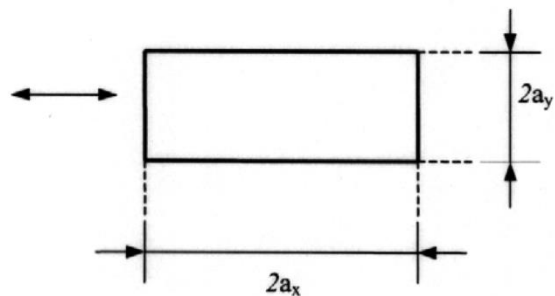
Definición de las dimensiones de una sección de pila rectangular
